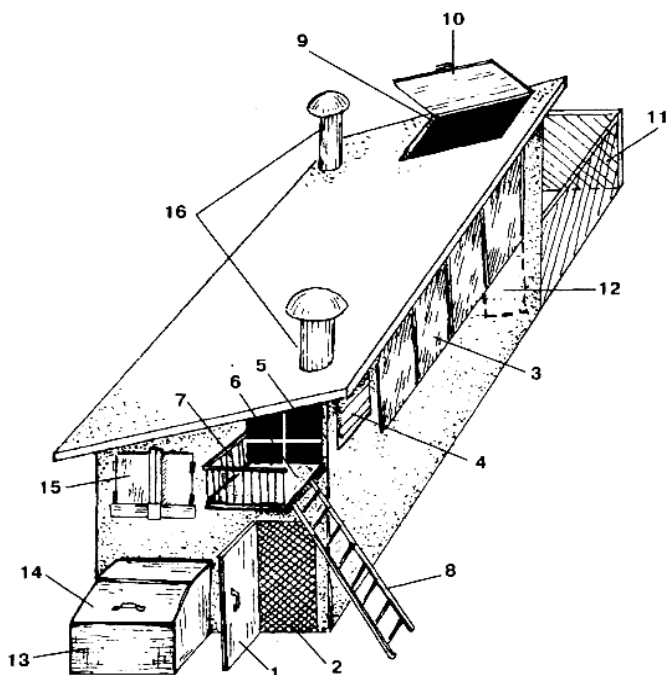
Общий вид крольчатника для личного подсобного хозяйства:
